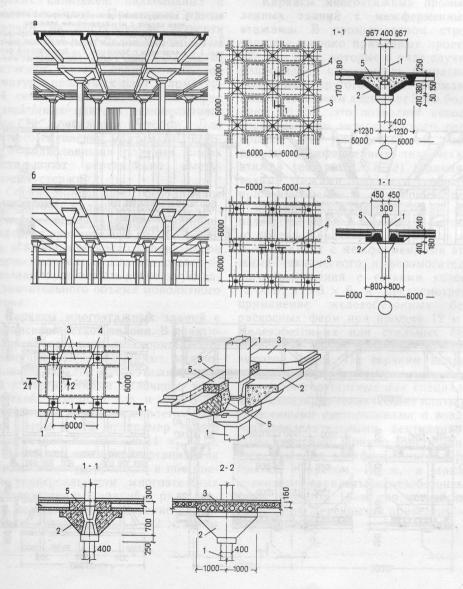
Полный сборный железобетонный каркас многоэтажного промышленного здания с перекрытиями безбалочного типа
